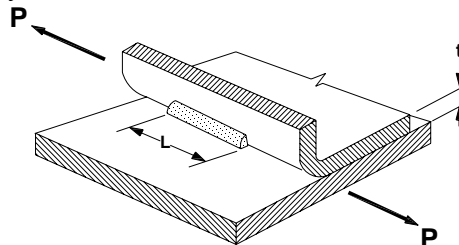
Cortante en soldadura de ranura biselada
